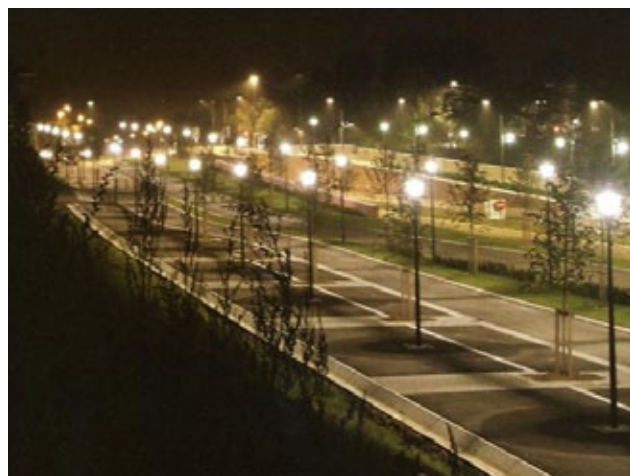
Slecht afgeschermd armatuur. Het licht schijnt in alle richtingen.
